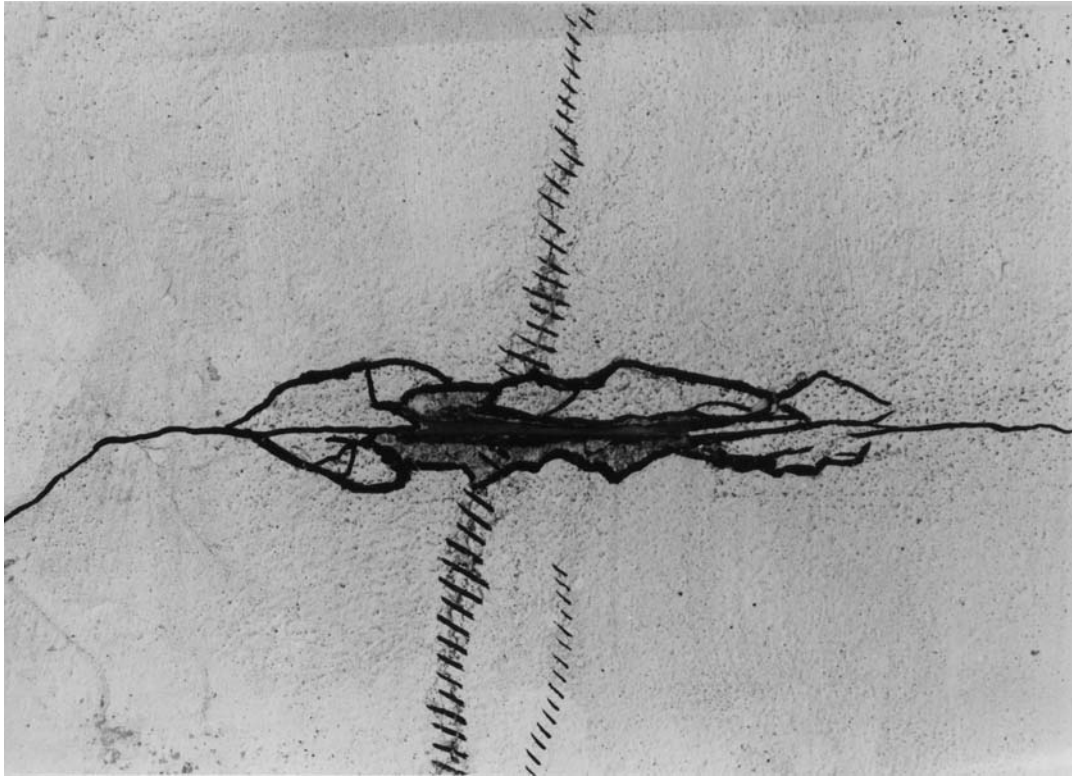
Ausschnitt aus Bild 3.69(b); Durch die großen Plattendurchbiegung herausgerissene obere Montagebewehrung; Die Schraffierung weist auf Zerstörungen der Betondruckzone in der Platte hin.
